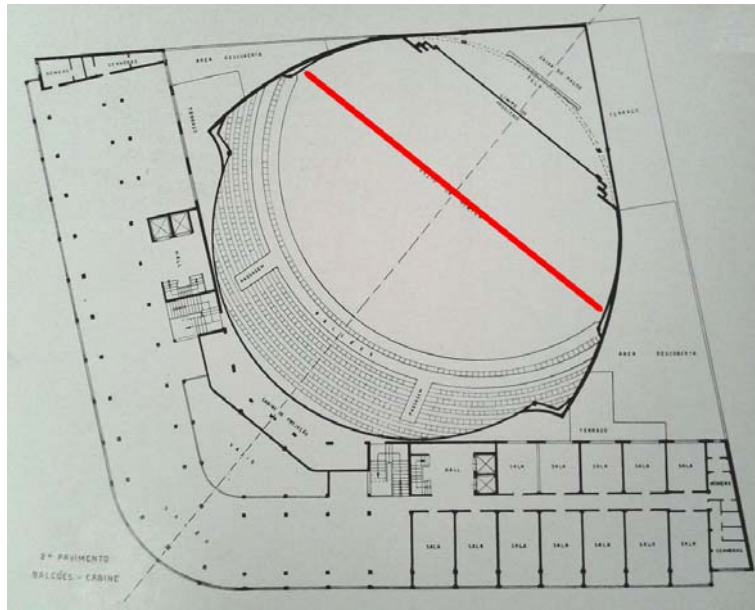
Croqui representando a disposição das novas salas de exibição. Fonte: autor.
